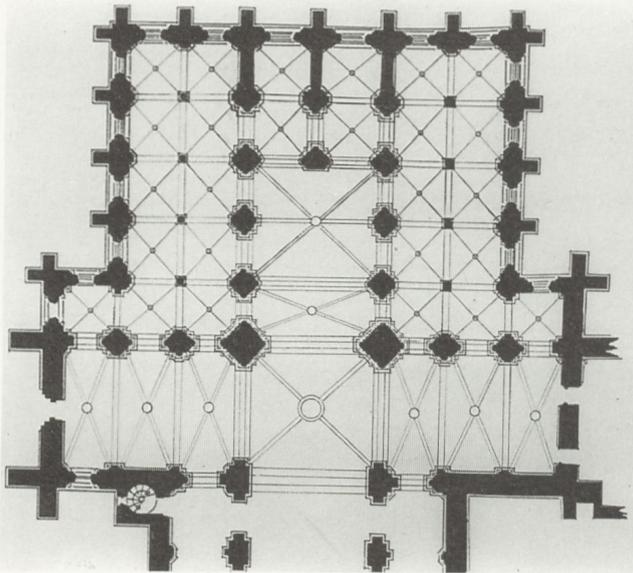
WALKENRIED, RECONSTITUTION DU PLAN DU XIII^e SIÈCLE, CHEVET
